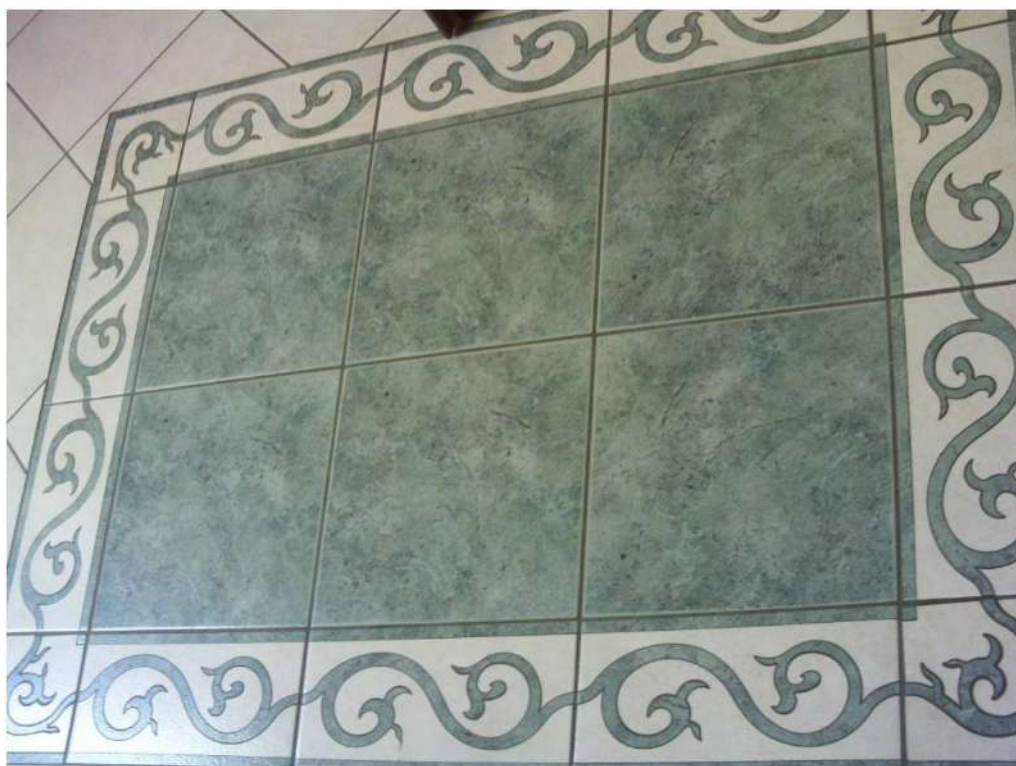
Foto interno : particolare pavimento – sub 2 piano 2°
